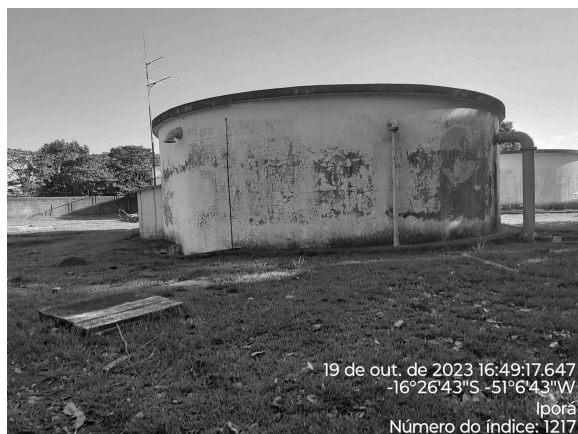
Área do booster Pará com muro de fundo danificado.
